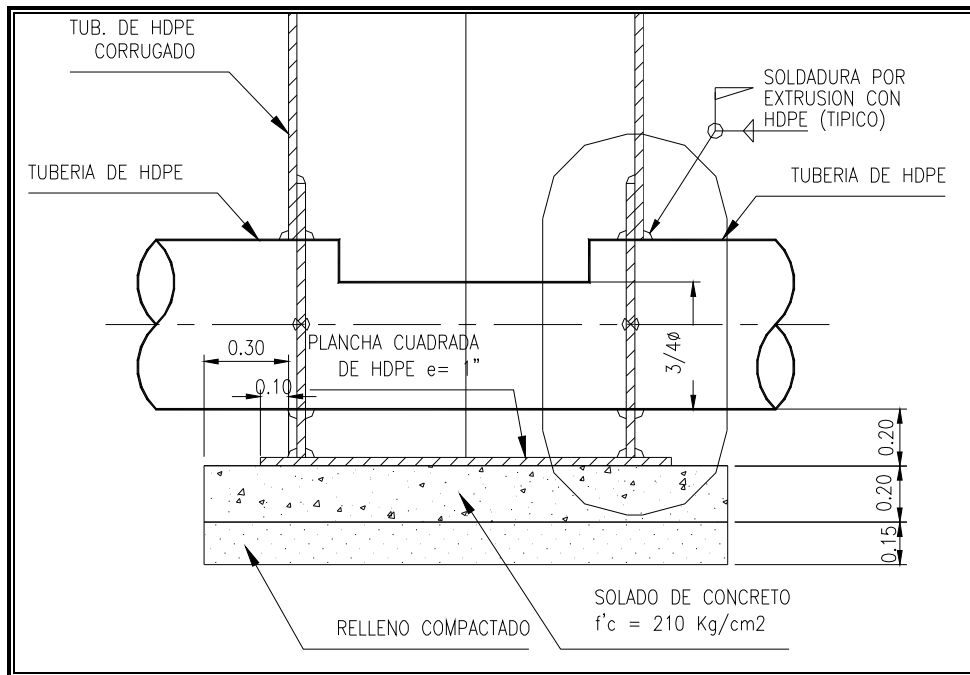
Detalle de Soldadura por Extrusión.
